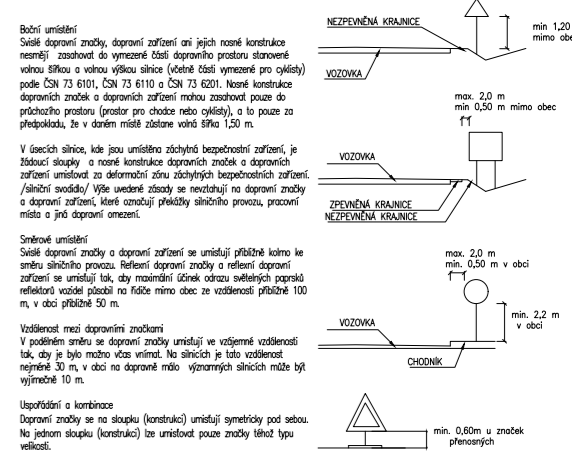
DETAIL UL. PILNÁČKOVA A BUZULUCKÁ
